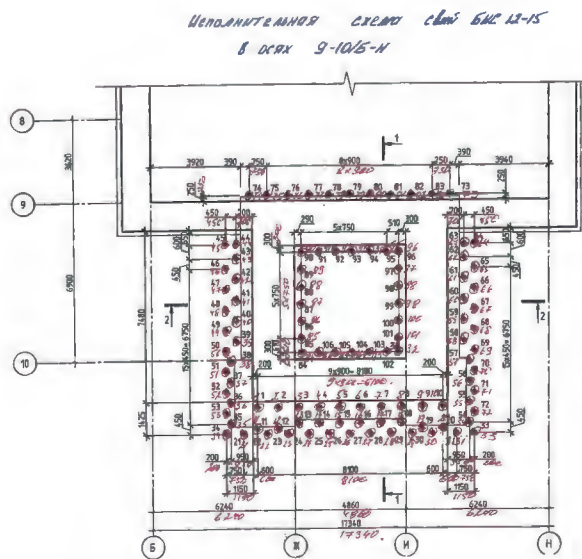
Усиление фундаментов путем устройства буронабортных свай (исполнительные схемы)
